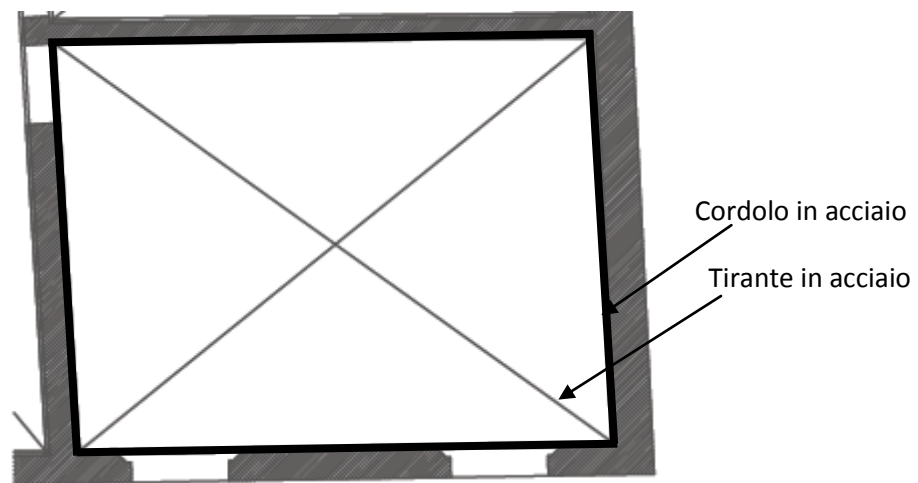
Individuazione degli elementi componenti la reticolare metallica
